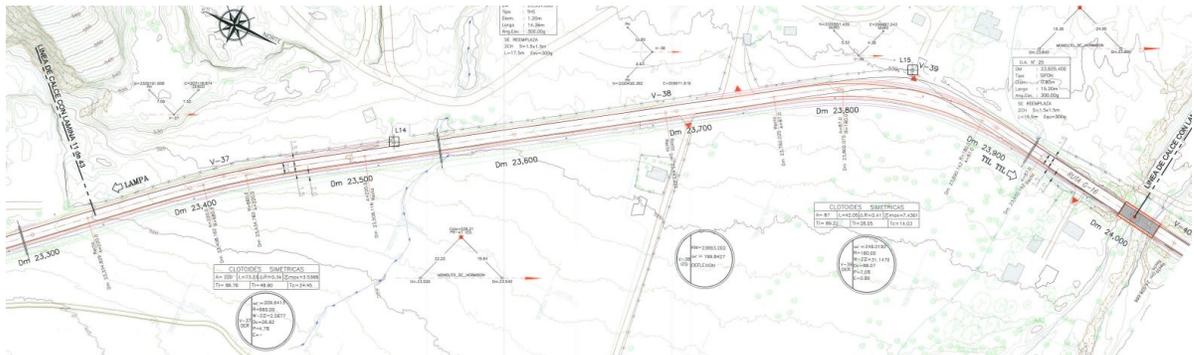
Plano de Planta y Perfil Longitudinal - Mejoramiento y Reposición de ruta G-16 - Sector Lampa.
